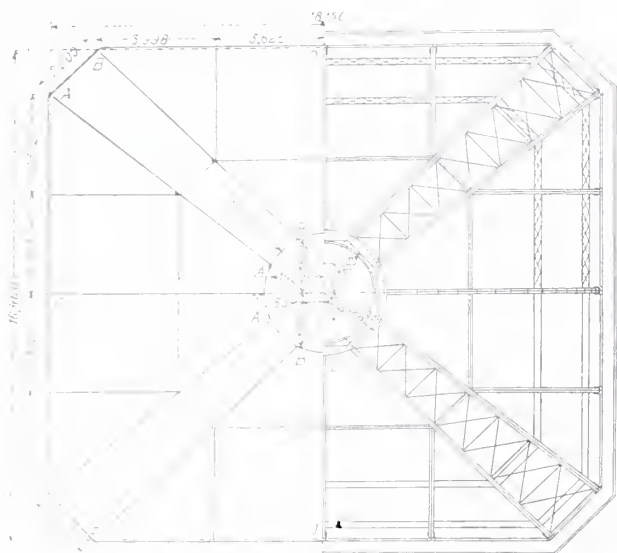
Grundriss der Kuppel. — Masstab 1:250.
